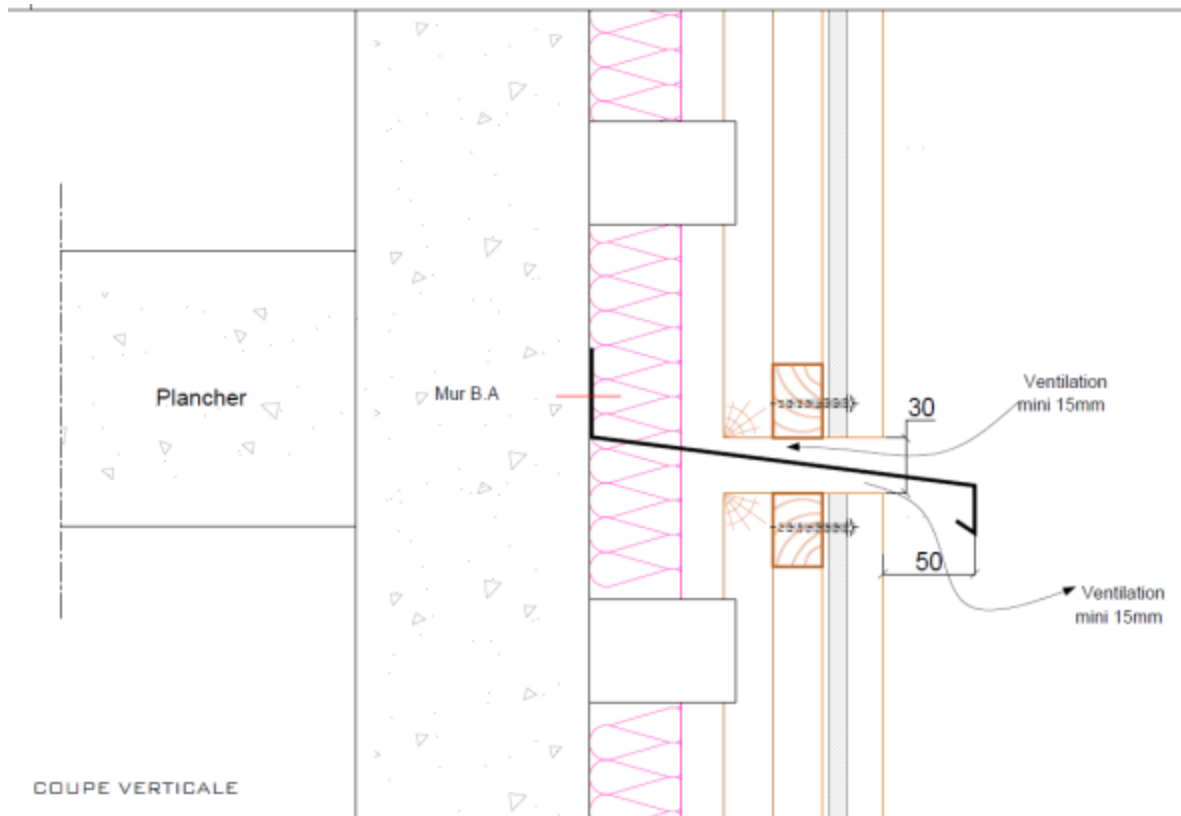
Fractionnement de l'ossature bois au droit de chaque plancher sur béton
